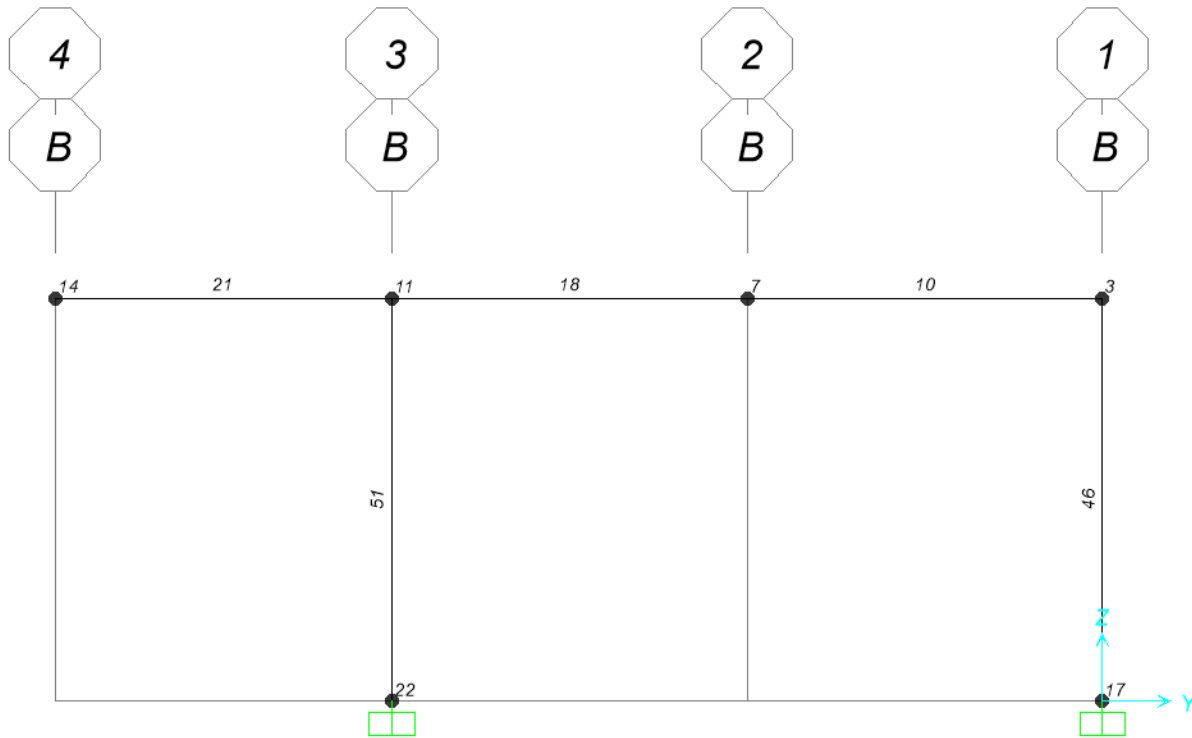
Vista in sezione modello struttura in elevazione –Filo B - numerazione elementi frame e joint
